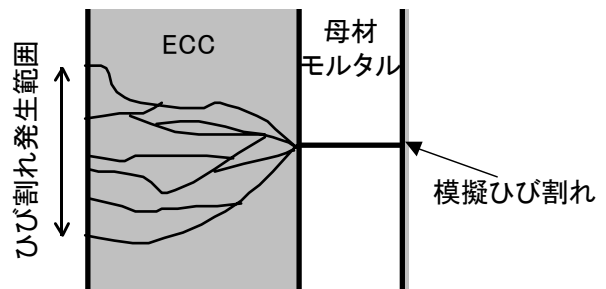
ECC 側面のひび割れ図（case0 終了後）
